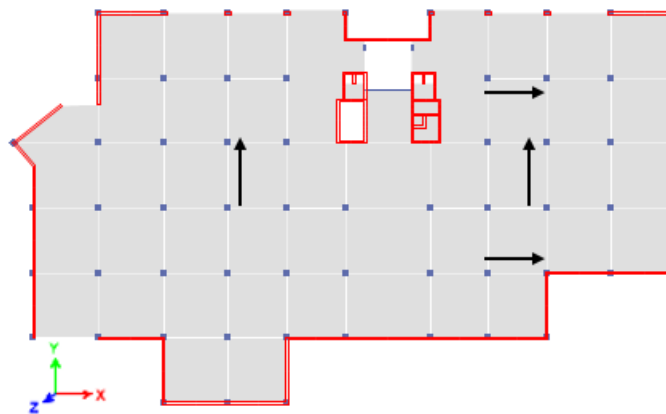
Esquema de ubicación de sensores en la Planta baja de la estructura. Instrumentación Tipo 4.
